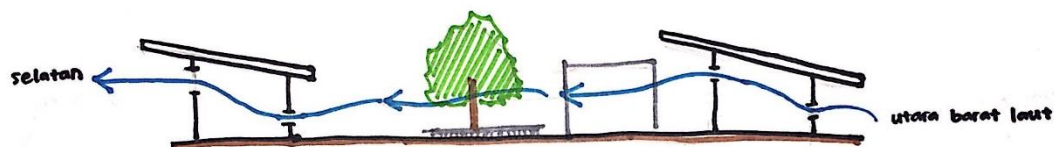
Skema Sistem Cross Ventilation Pada Bangunan
